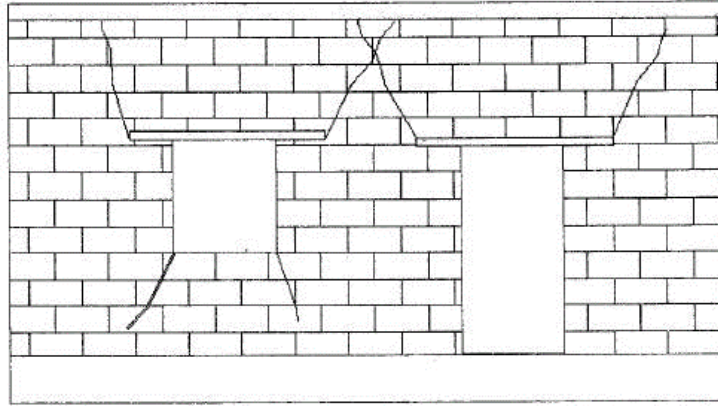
Grietas en las aberturas (Comité nacional des constructions en terre, 2013)
